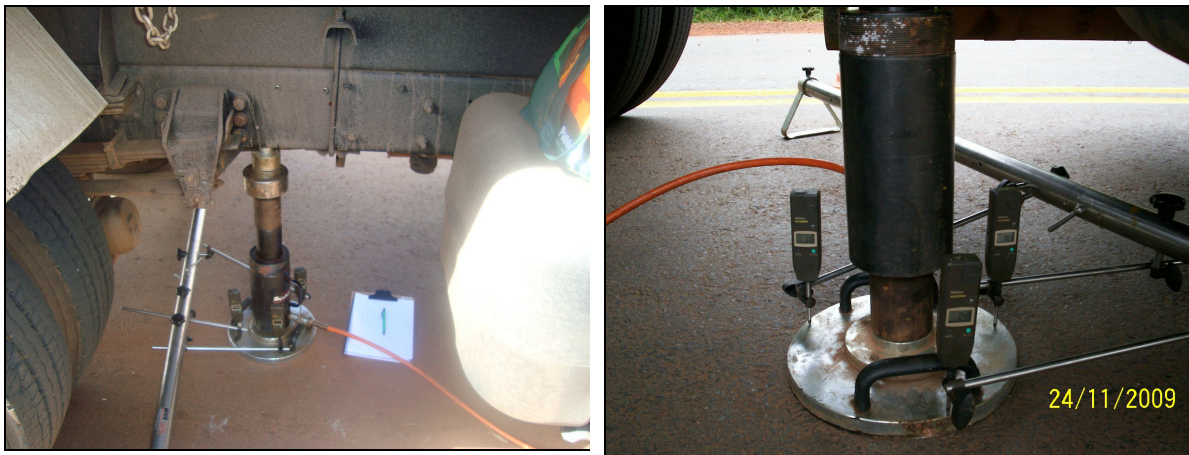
Disposição dos equipamentos para ensaio de Prova de Carga Sobre Placa.
